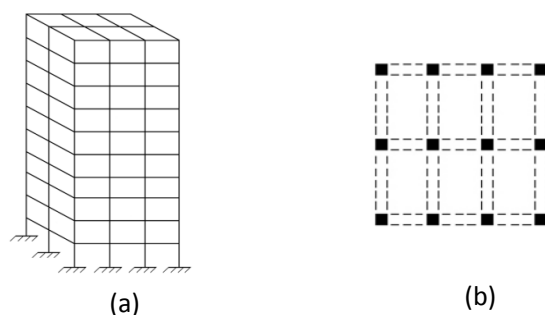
Structure de trame rigide (a) élévation, (b) vue en plan
